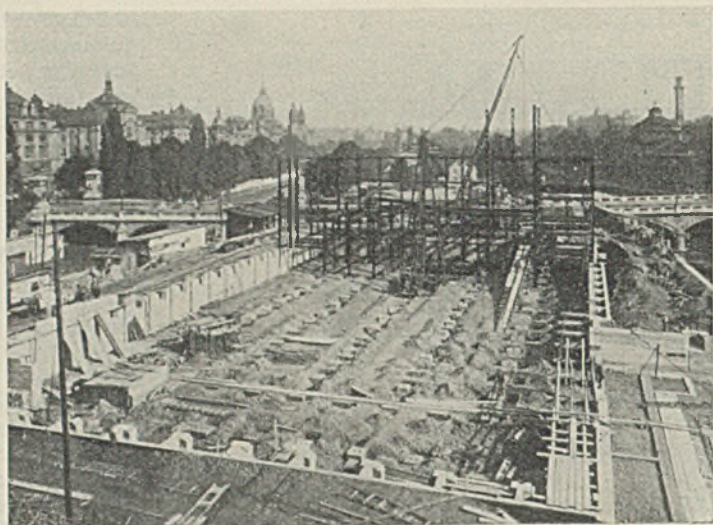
Montage des Saalbaues mit Hilfe eines fahrbaren Schwenkkranes.
